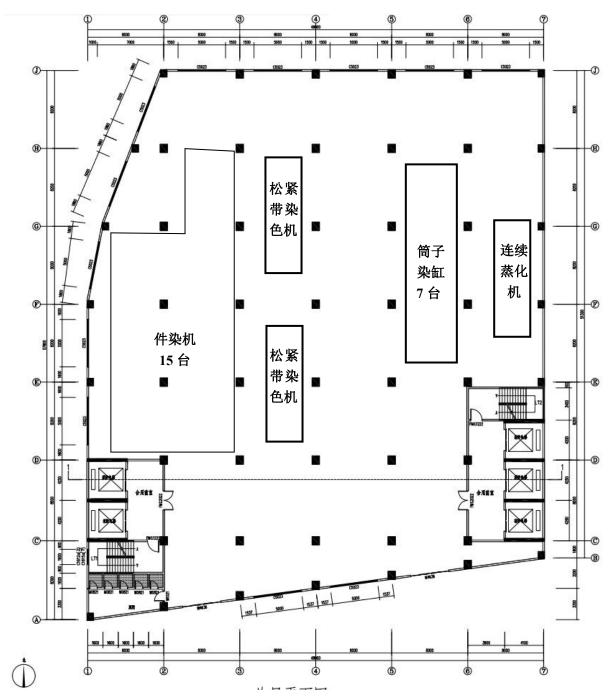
原有项目(B 栋厂房) 8 楼平面布置图
